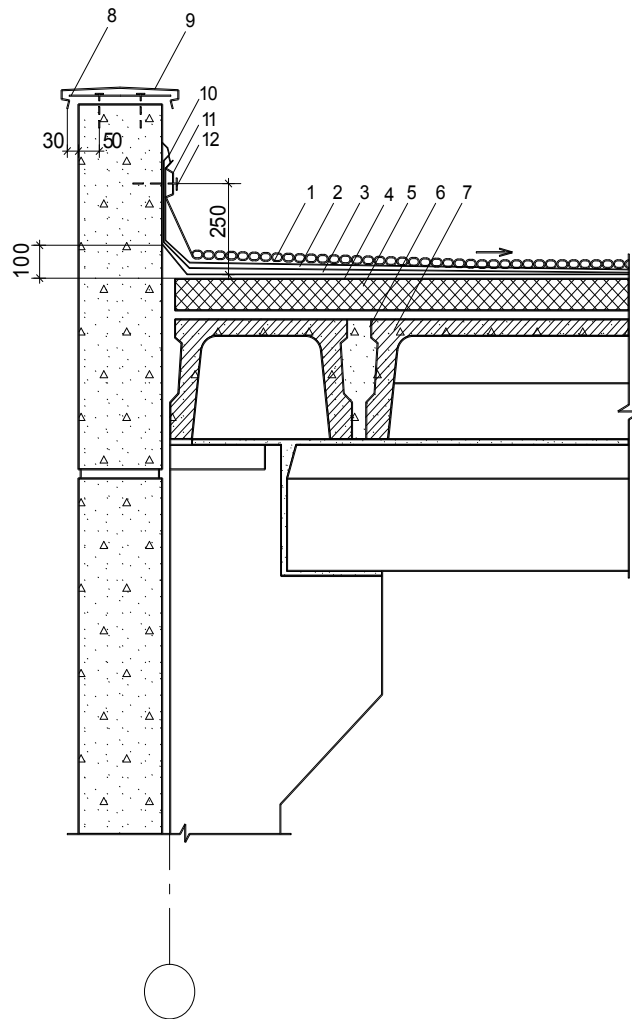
Парапет поздовжньої стіни при ригелях з полицями:
